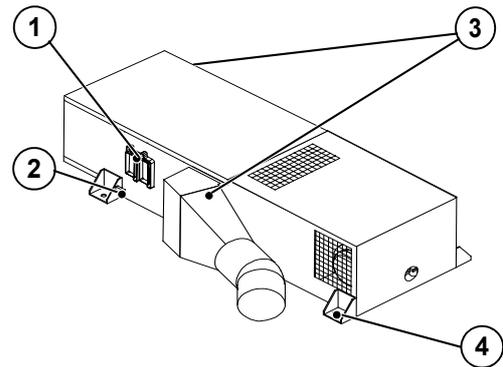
Smontaggio del gruppo monoblocco del condizionamento
